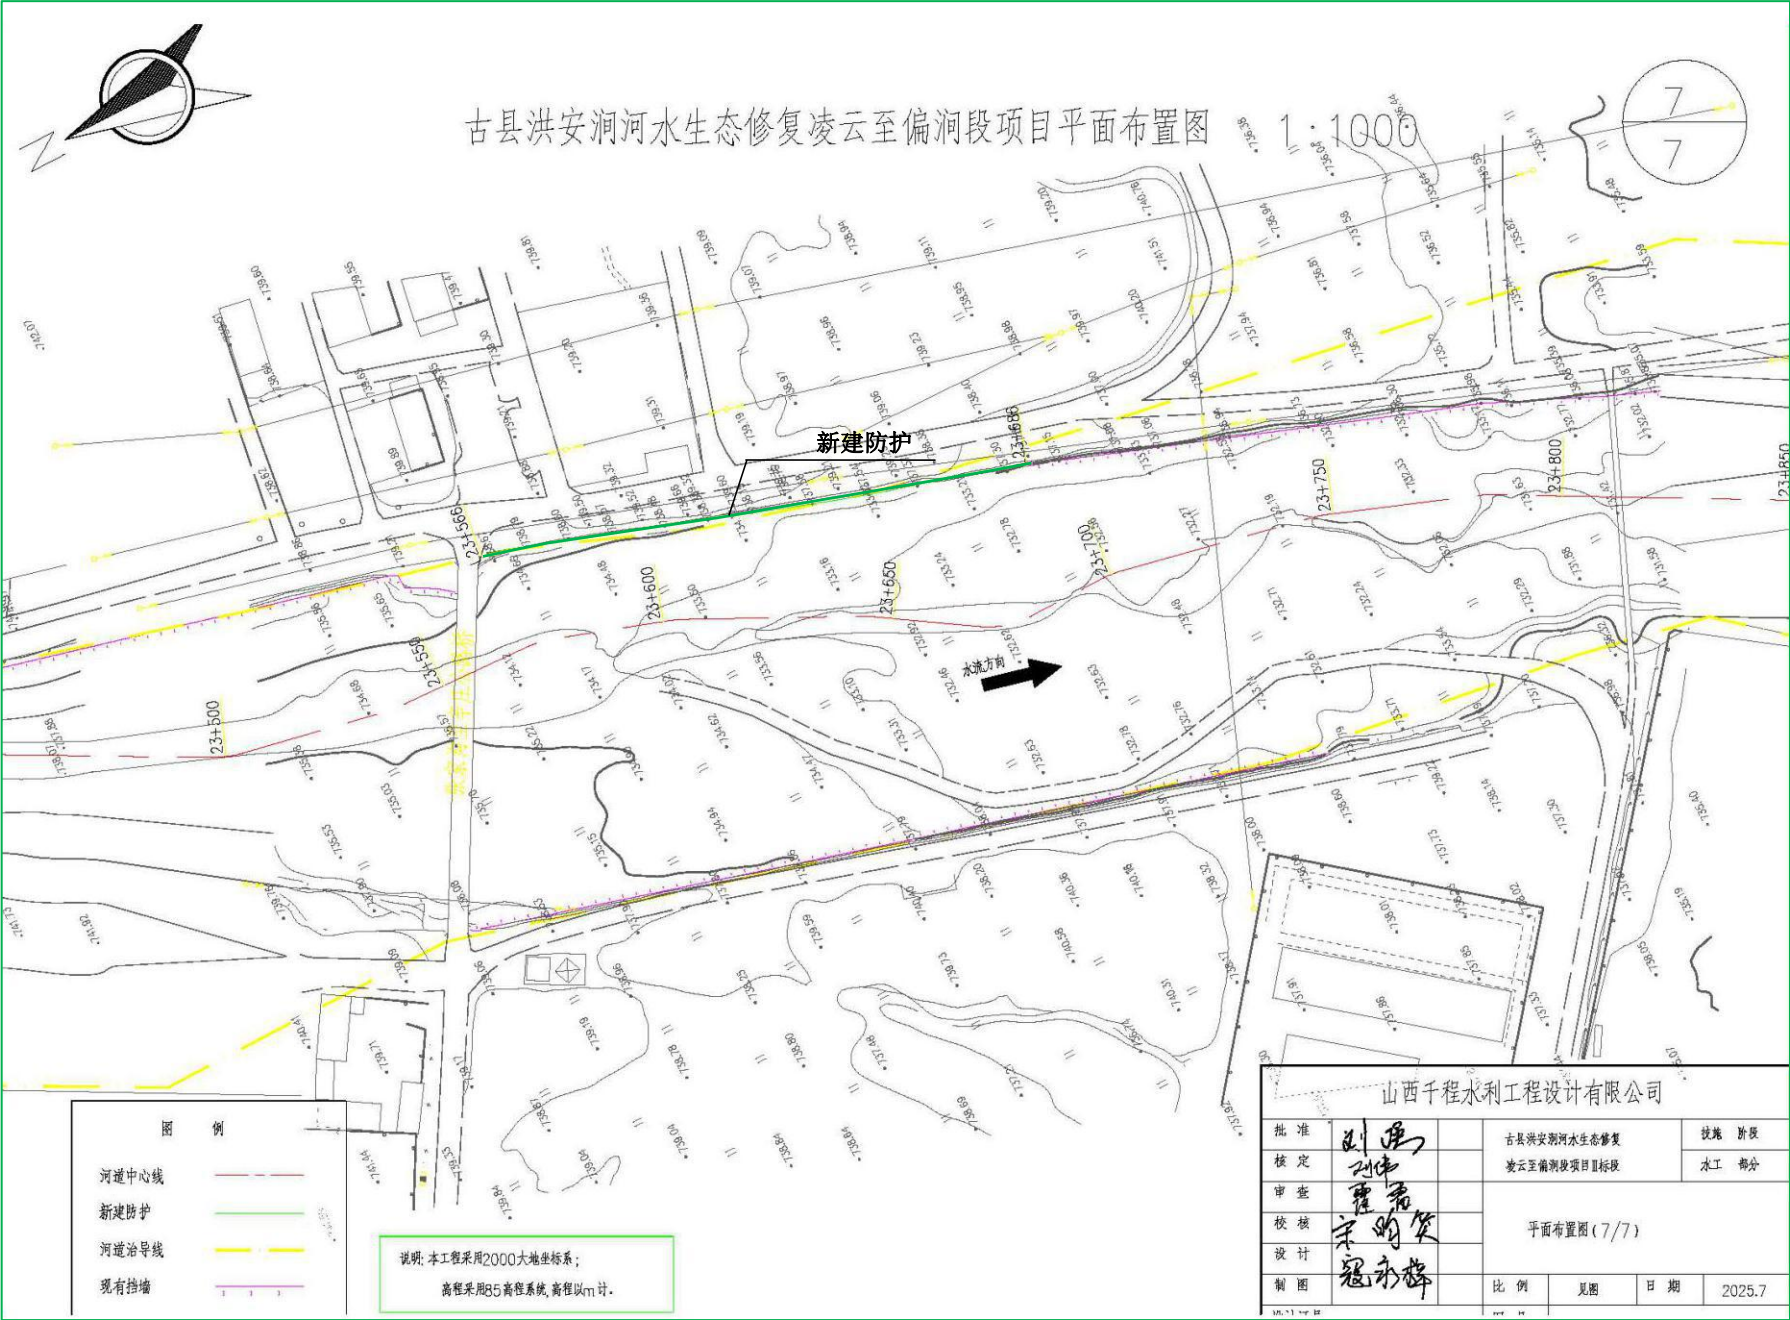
(11) 工程总平面布置图(桩号 23+500-23+850)
